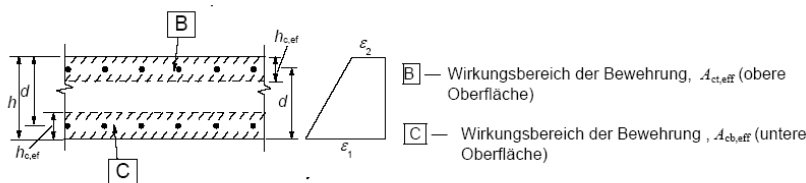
DE – Vergrößerung der Höhe $h_{c,ef}$ des Wirkungsbereiches der Bewehrung bei zunehmender Bauteildicke
